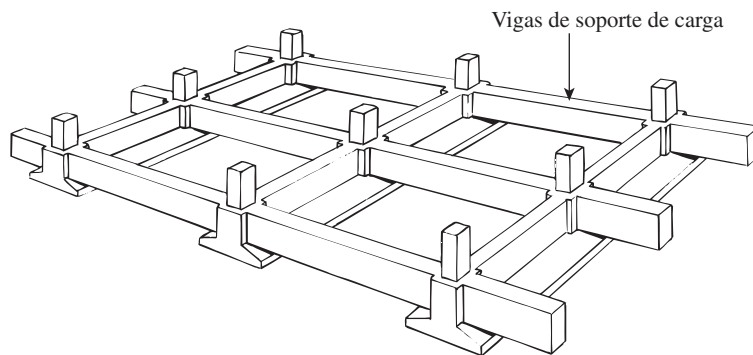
Cimentación continua con vigas de soporte de carga. [De Clemence, S.P. y Finbarr, A.O. (1981) "Design Considerations for Collapsible Soils", *Journal of the Geotechnical Engineering Division*, American Society of Civil Engineers, vol. 107, GT3, pp. 305-317. Con permiso de la ASCE].
